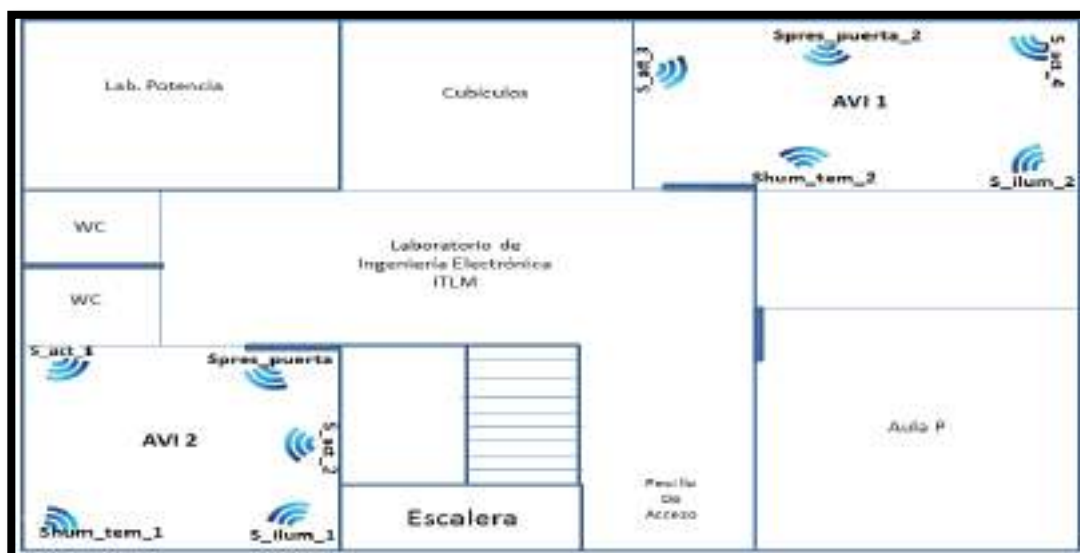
Vista arquitectónica de la planta del recinto de prueba.
